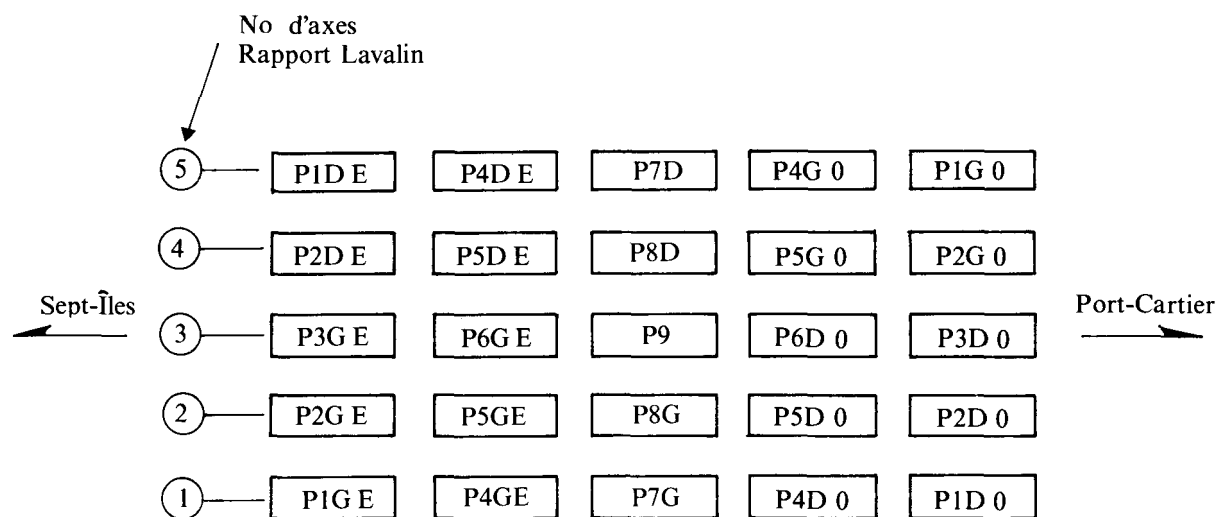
Schéma des poutres avec la codification du fabricant
